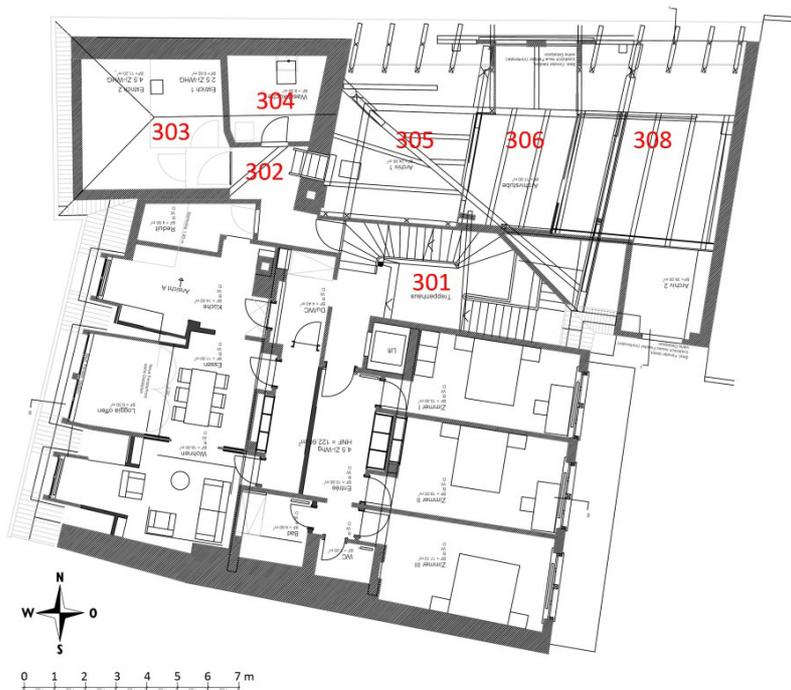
Korporationsgebäude. Grundriss 1. Dachgeschoss (Nordhaus) und 3. Obergeschoss (Südhaus). Plangrundlage: Projektplan, März 2017.
